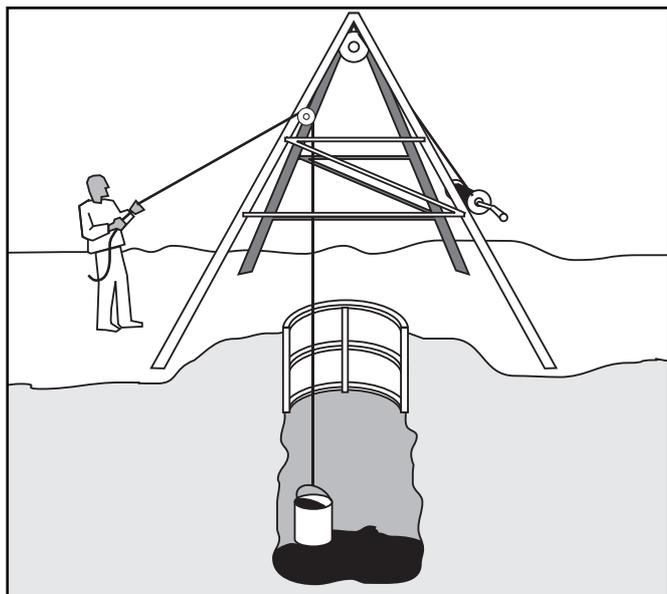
Exemplo de construção de um poço escavado manualmente I
